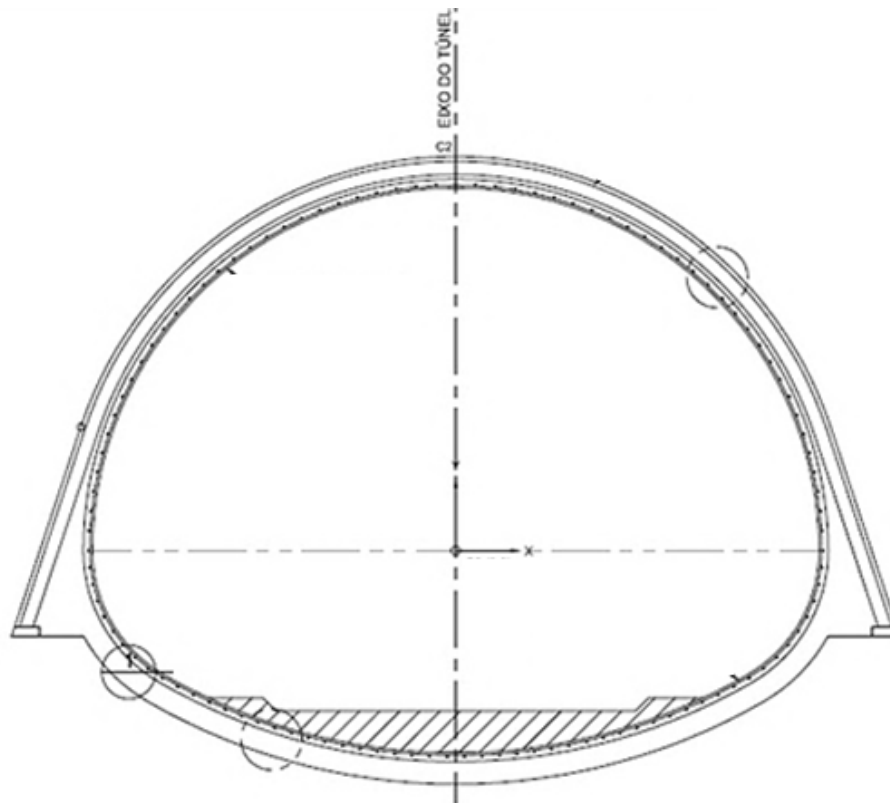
Seção de execução do túnel – Segunda fase. (Acervo Terratek 2013)
